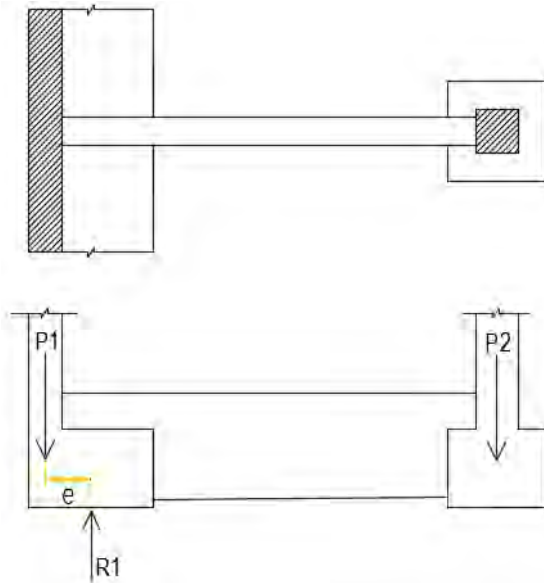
Idealización para análisis de cargas en la viga de cimentación VC-03.
